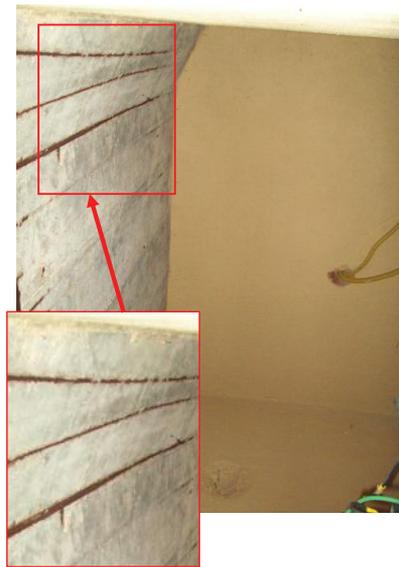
Corrosão de armaduras na escada de acesso ao segundo pavimento.
